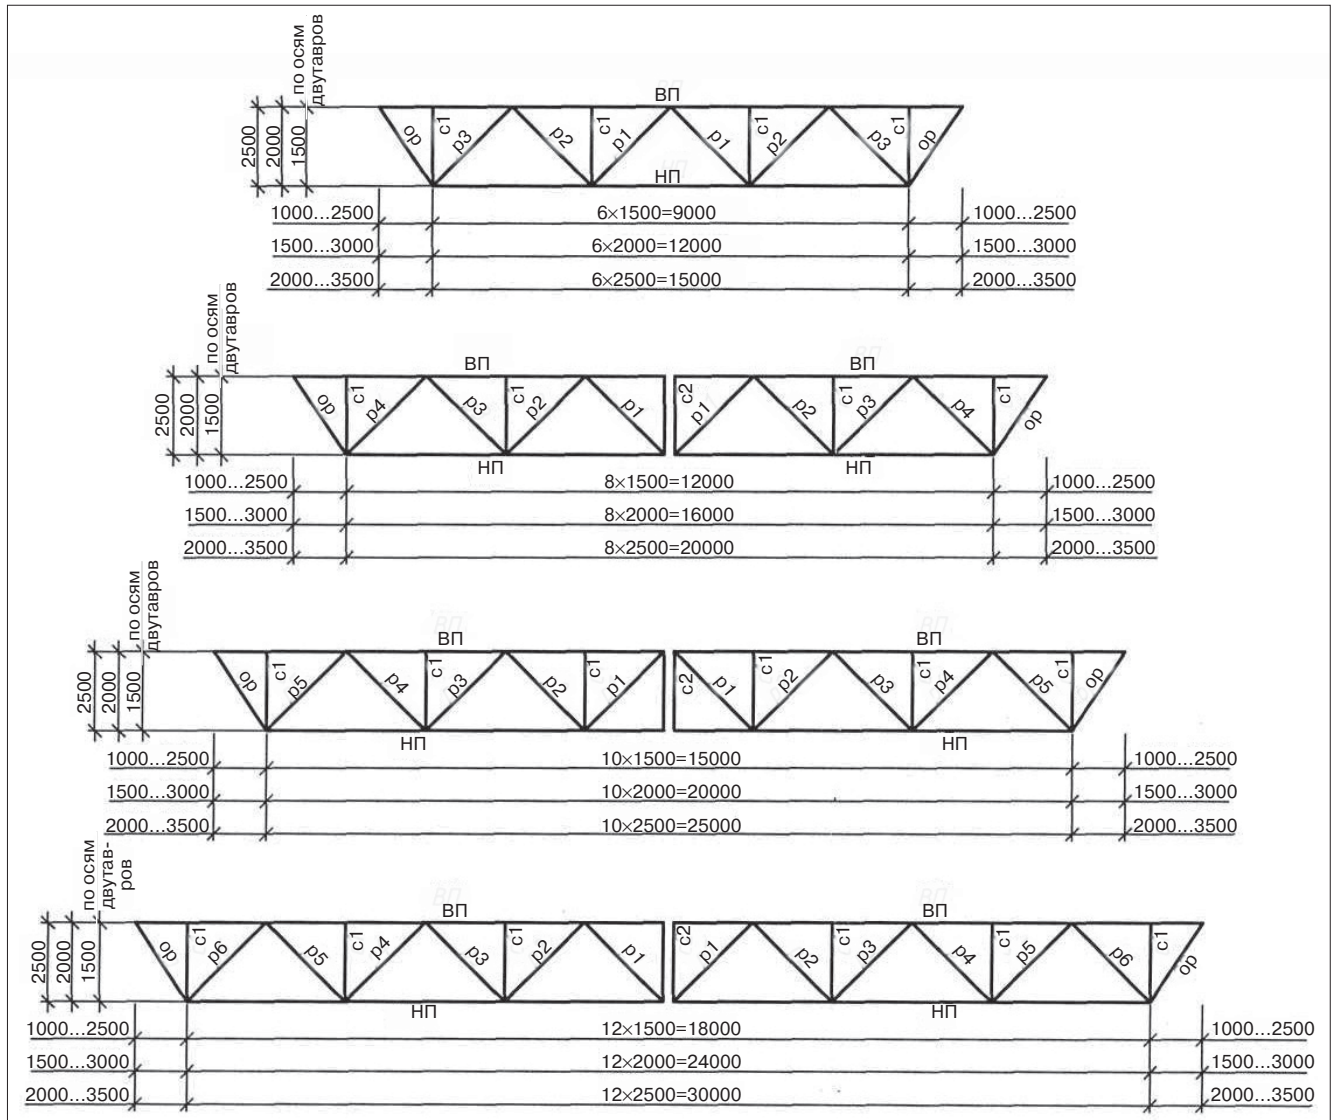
Схемы стропильных ферм Фсв: ВП – верхний пояс; НП – нижний пояс; с1, с2 – стойки; р1–р6 – раскосы; ор – опорный раскос
